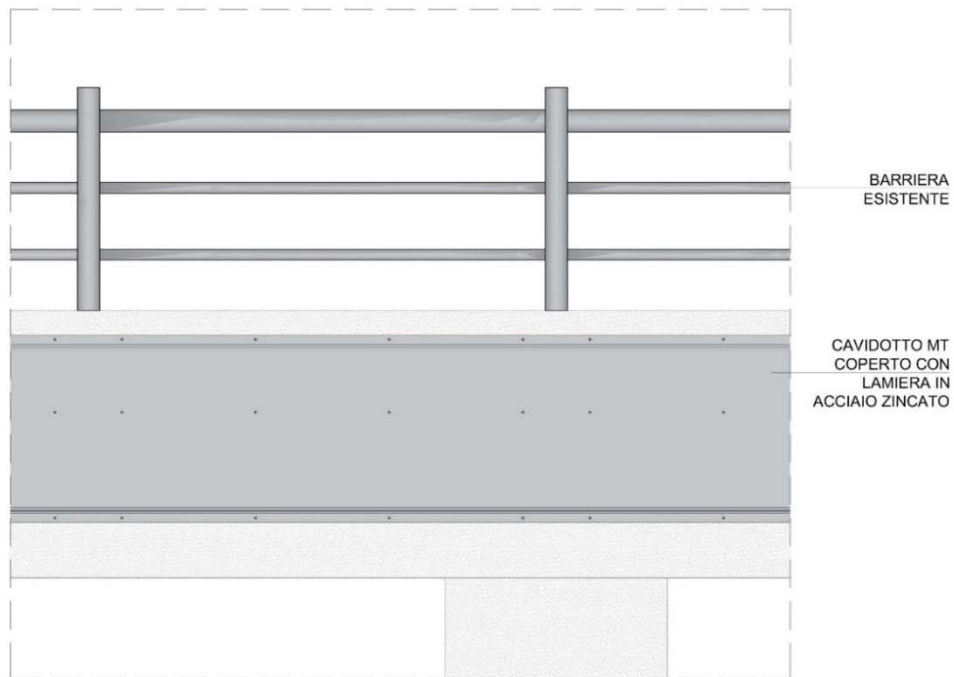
Particolare costruttivo dell'attraversamento ponte con staffaggio laterale
